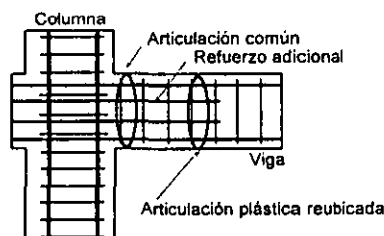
Detalle de conexión viga-columna para formar la articulación plástica lejos de la cara de la columna propuesta por Abdel-Fattah y Wight
